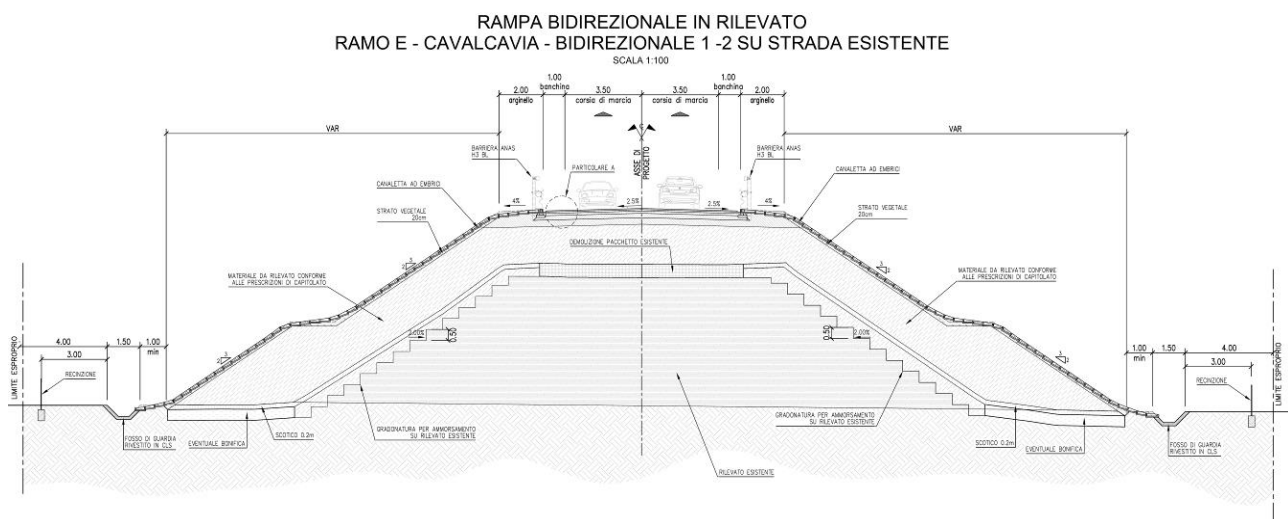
Sezione tipo rampa Bidirezionale con ammorsamento su rilevato esistente
